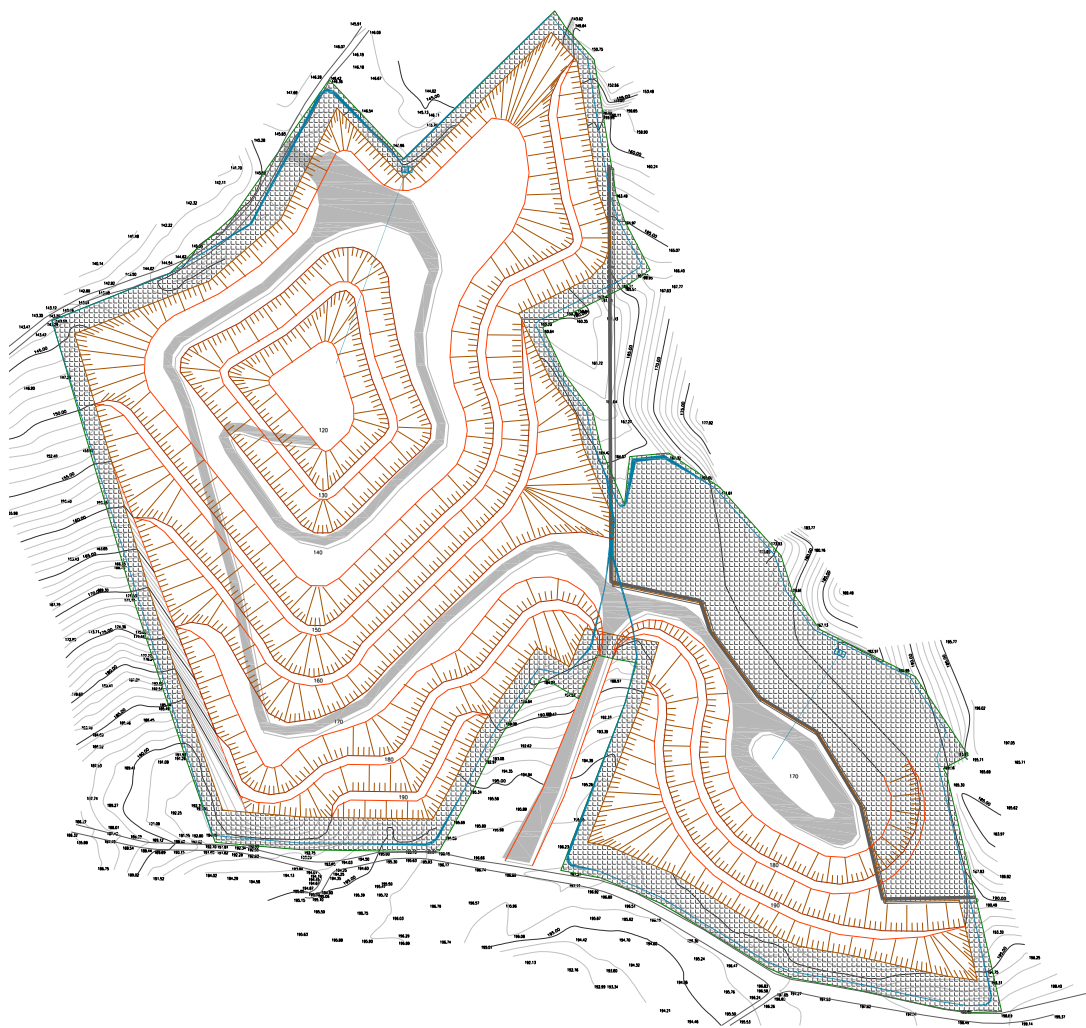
Planta esquemática da configuração final de lavra da pedreira (sem escala).
